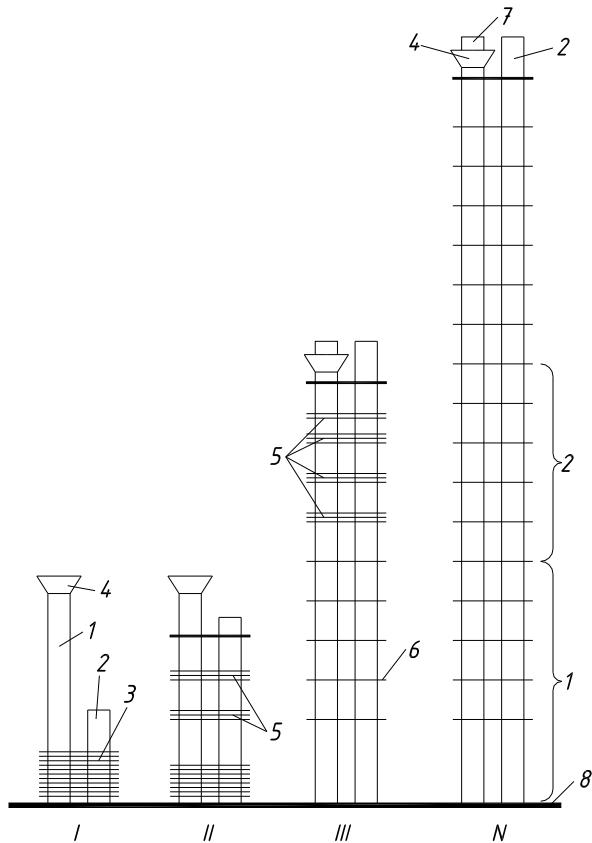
Технологическая схема возведения зданий методом подъема перекрытий:
